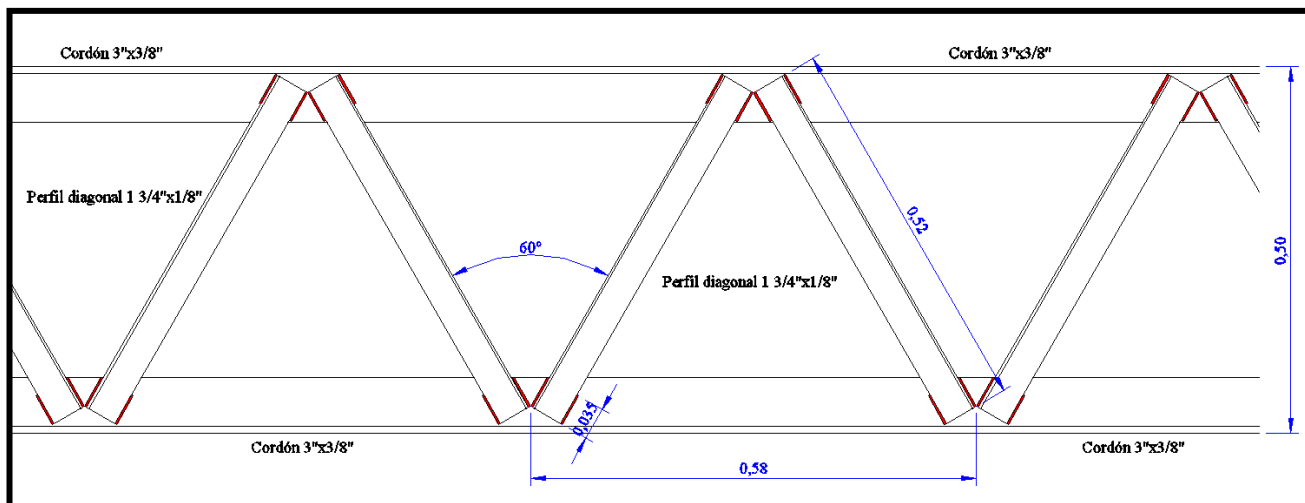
Detalle unión soldada diagonales-cordones.
